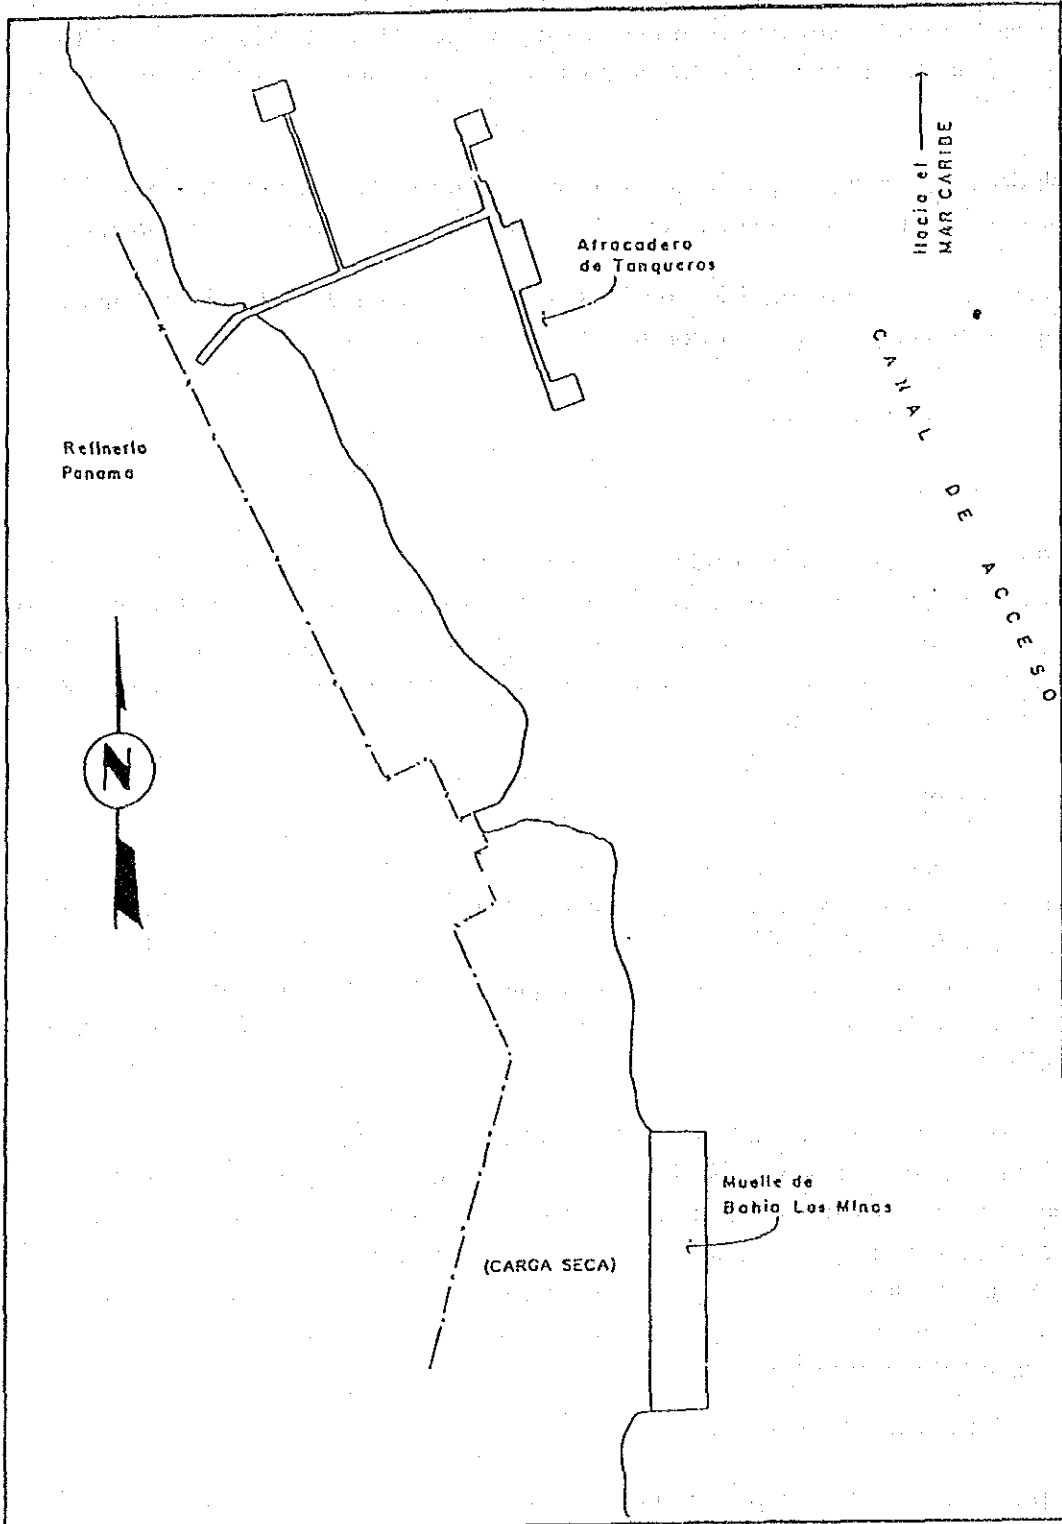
Planos del Puerto de Bahía Las Minas
